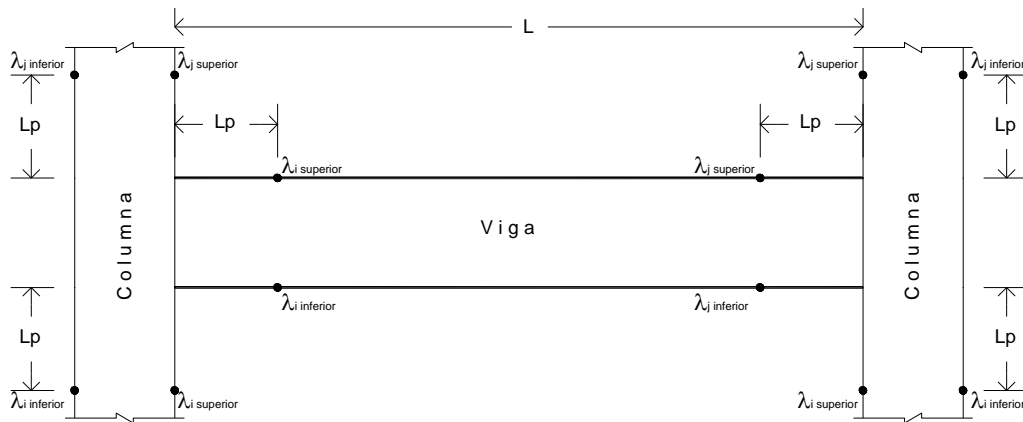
Ubicación de los índices de daño locales en los elementos estructurales (viga-columna)
